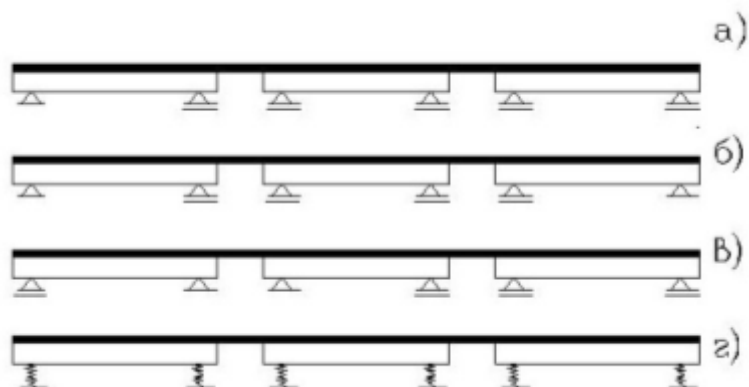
Сглобяемо- монолитна непрекъсната конструкция
